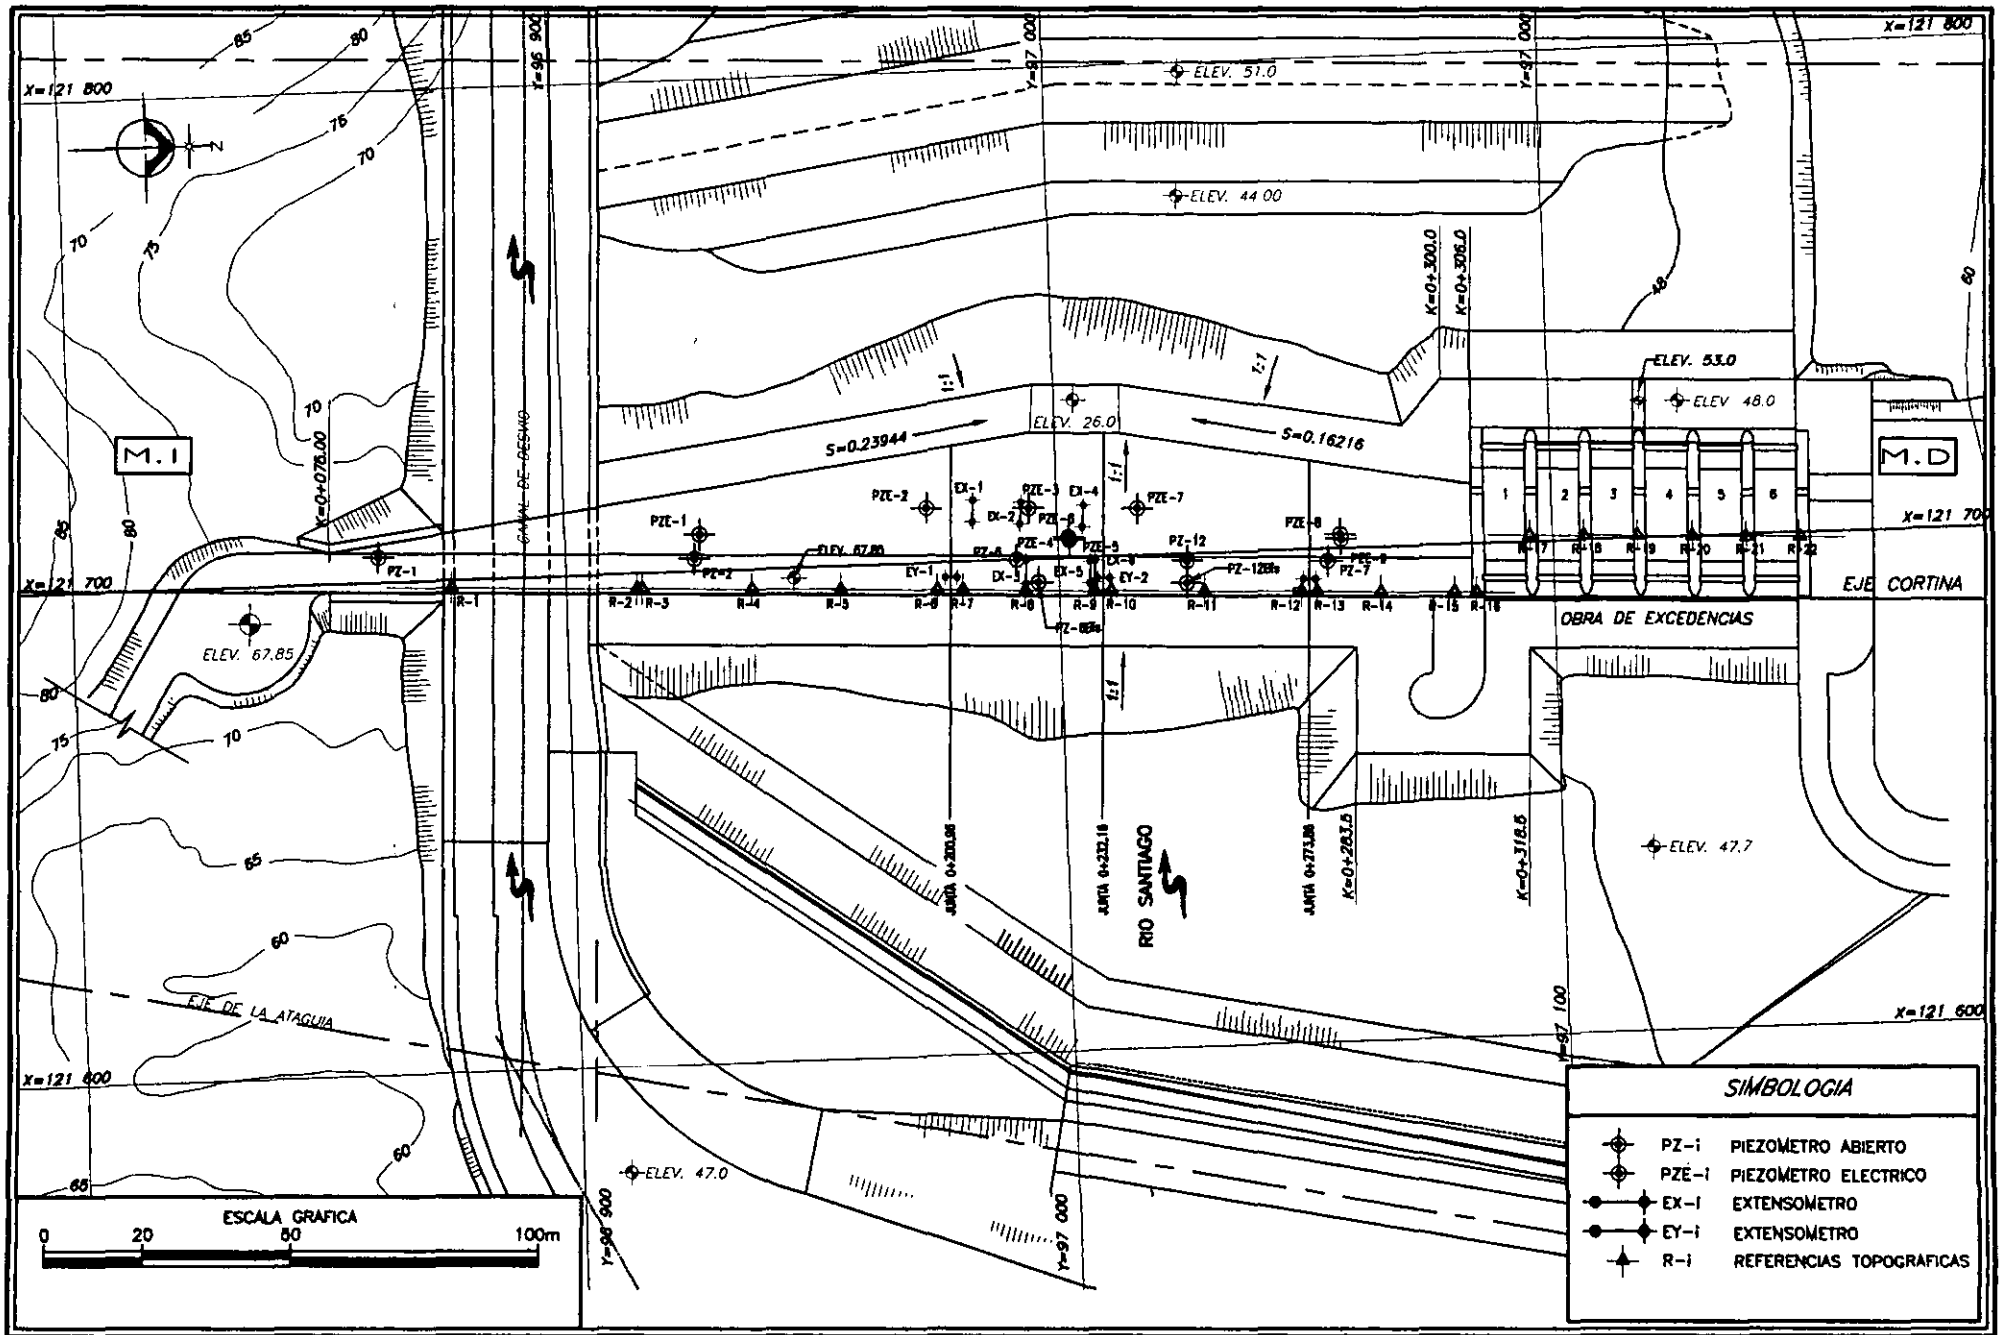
Localización en planta del sistema de instrumentación instalado en la P.R.H. San Rafael, Nay.
